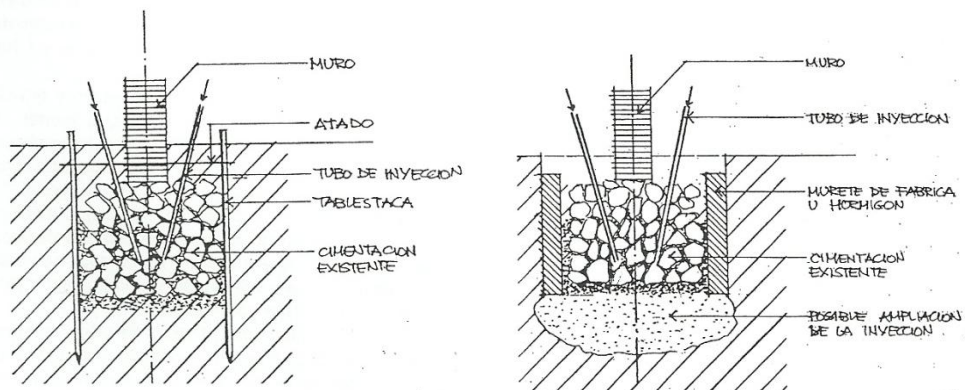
Refuerzo cimentación mediante inyección confinada por tablestacado o muretes de fábrica (Monjo, et al., 2001).
